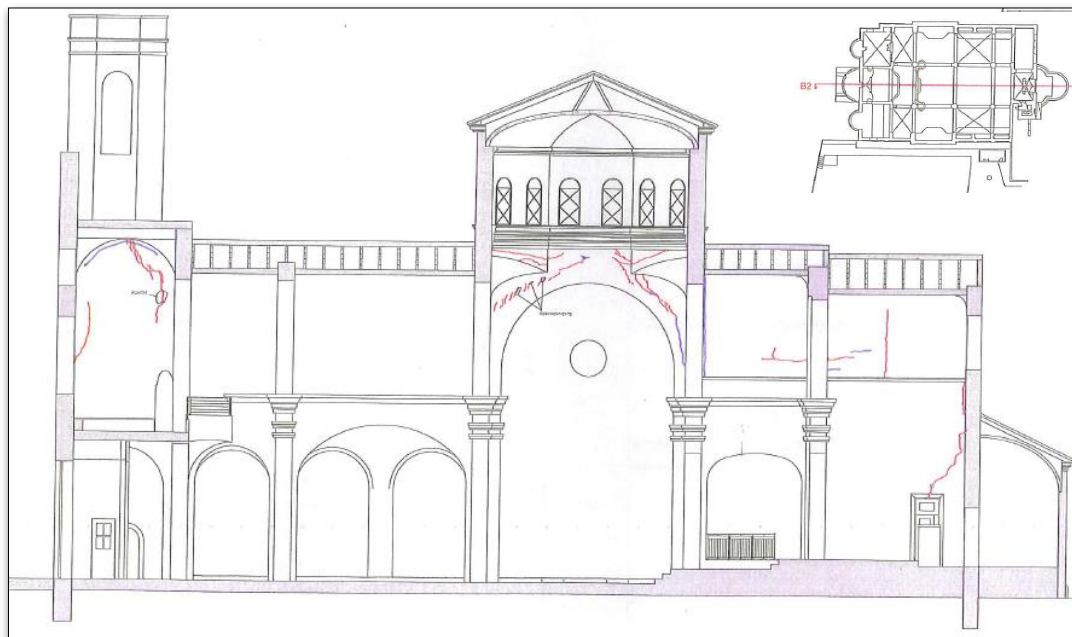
Grietas sección longitudinal central 2 (plano PAT. 13)
